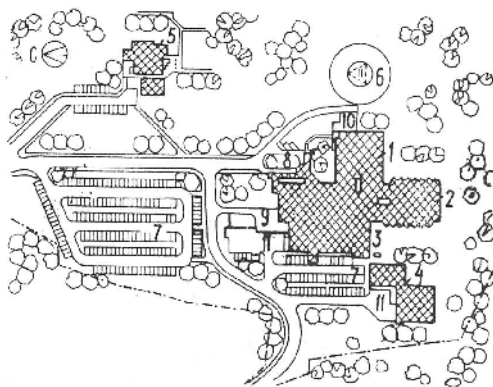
Больница в г. Гусшенхаузен (Германия). Генплан участка: 1 – восточный палатный корпус; 2 – южный палатный корпус; 3 – лечебный корпус; 4 – котельная и прачечная; 5 – школа медсестер и жилой корпус; 6 – вертолетная площадка; 7 – открытая автостоянка; 8 – планый вход; 9 – подъезд для лежачих больных; 10 – вход в инфекционное отделение; 11 – хозяйственный вход (в уровне подземного этажа)
